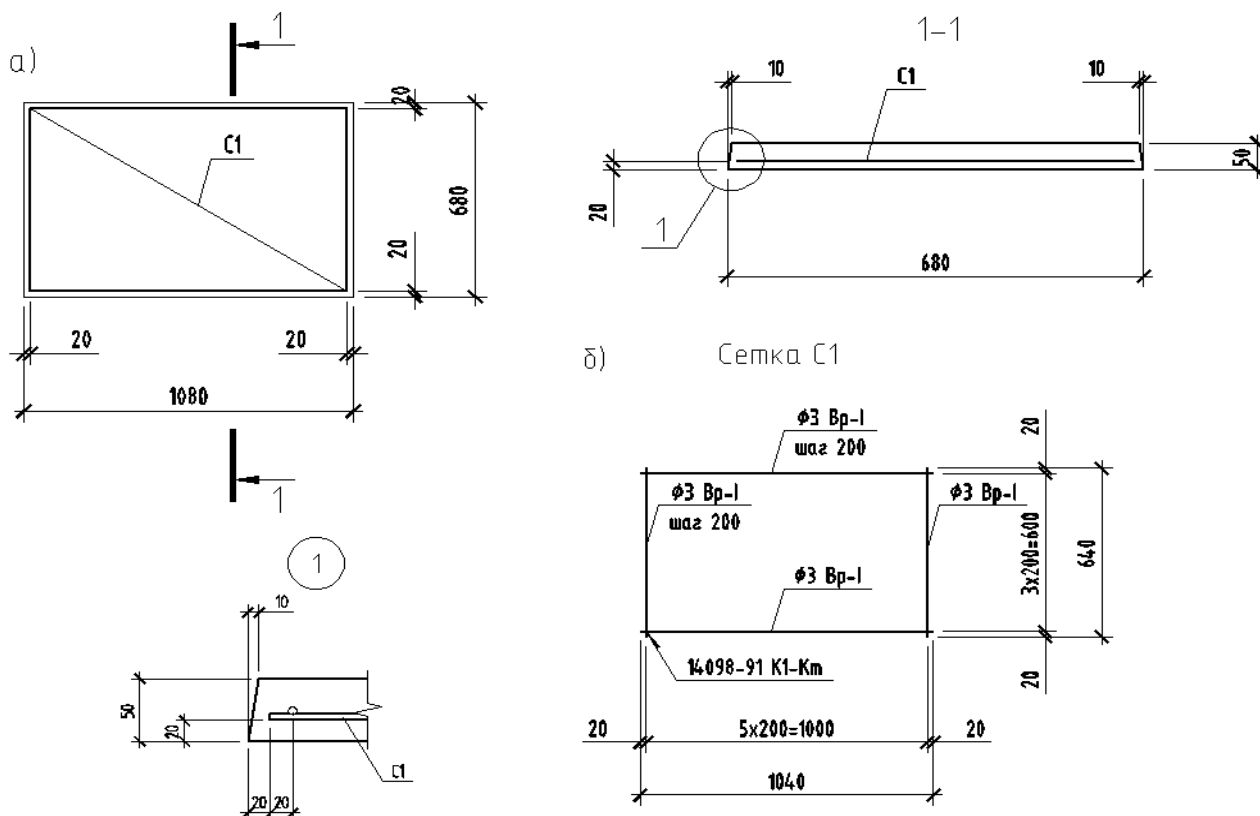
Опытный образец: а - схема конструктивного решения, б- армирования
